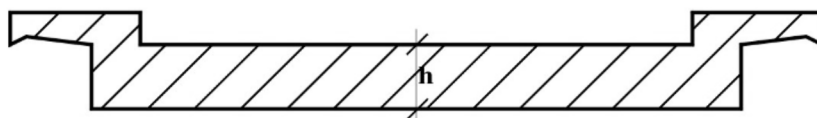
Vigas e lajes de concreto moldadas no local
